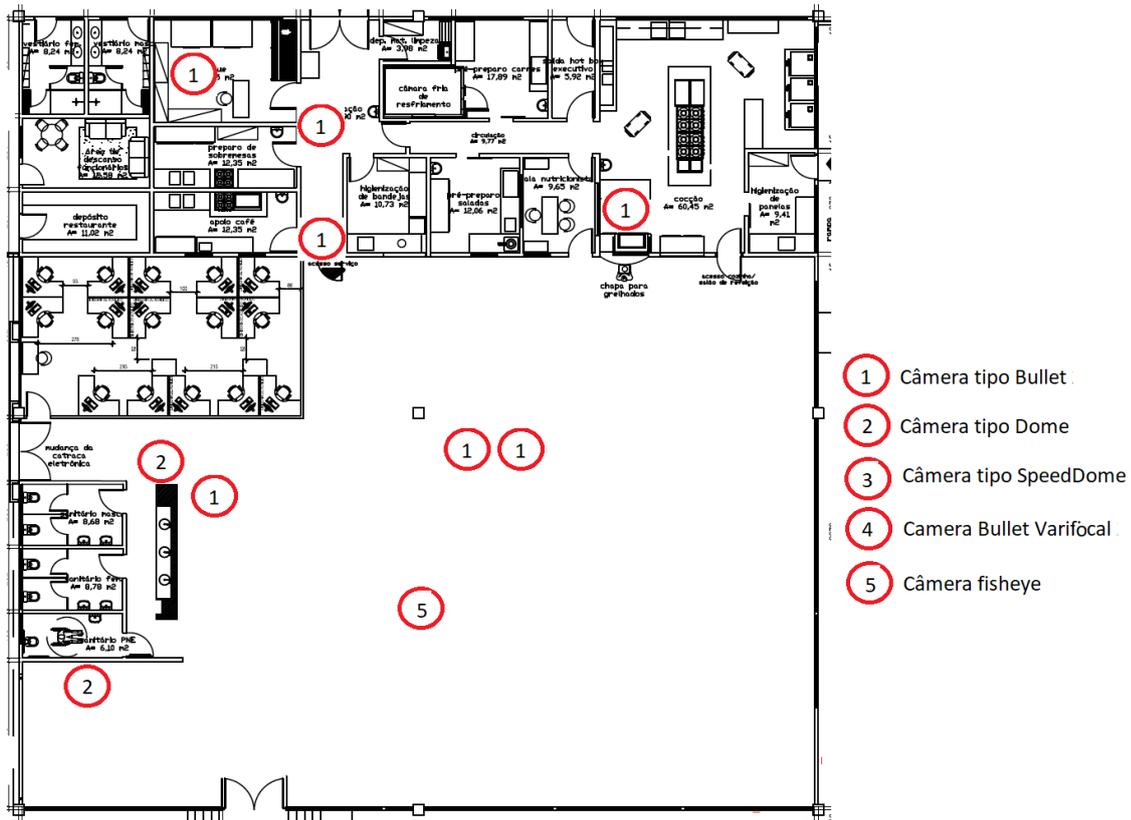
Esboço de posicionamento de câmeras para o bloco restaurante;
